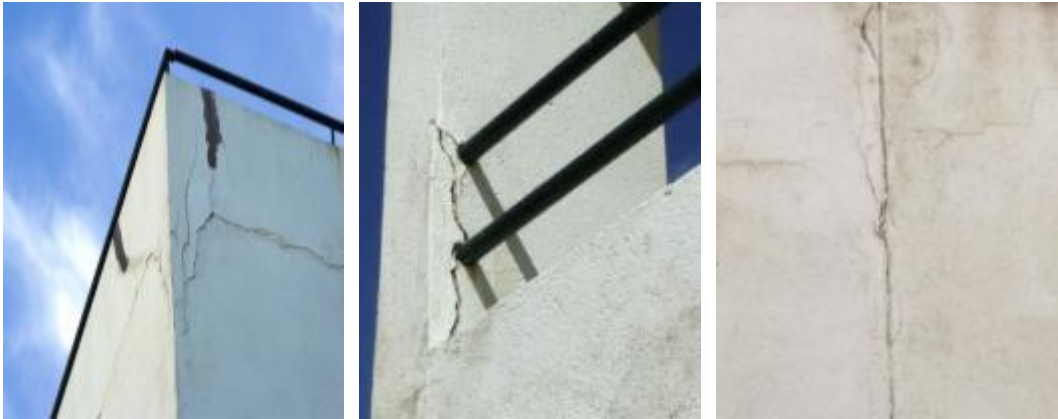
Fenómenos de fissuração (paramentos e guardas) e deterioração de junta de dilatação
